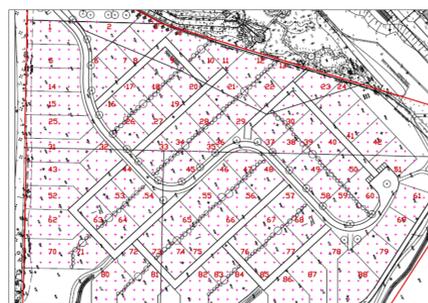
Übersichtslageplan Neigungsrastrer mit Grundstücksnummern
